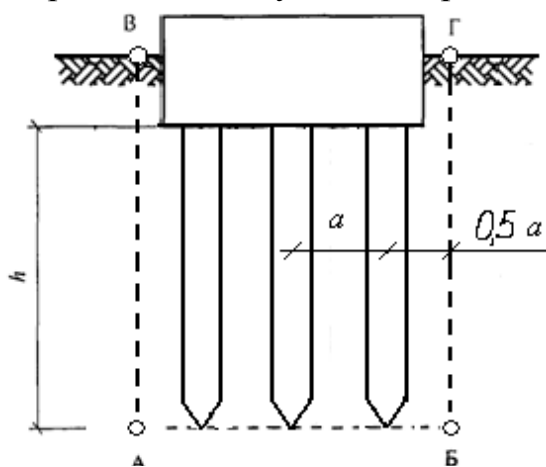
Определение границ условного фундамента при расчете осадки свайных фундаментов снизу – плоскостью АБ, проходящей через нижние концы свай;
